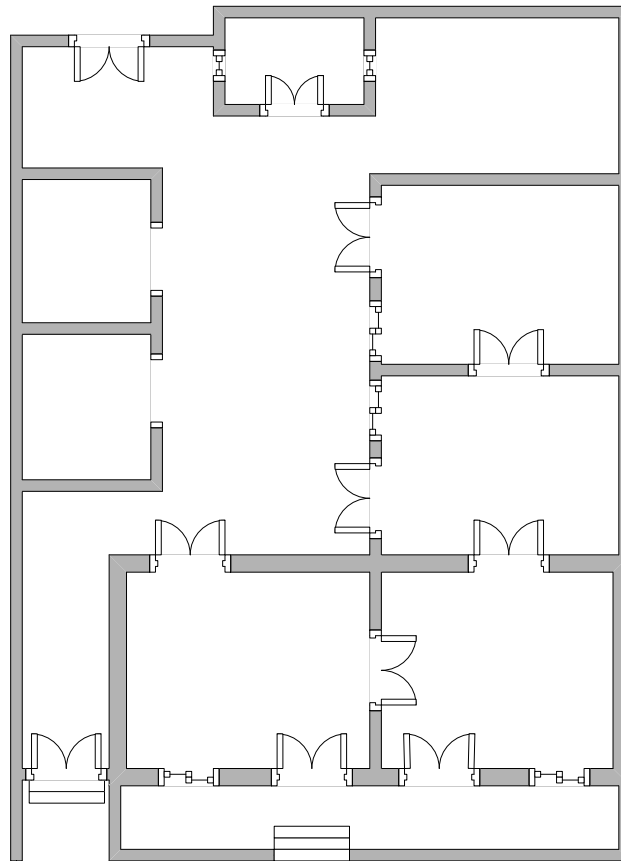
Planta reconstituída da habitação senhorial em estudo.
